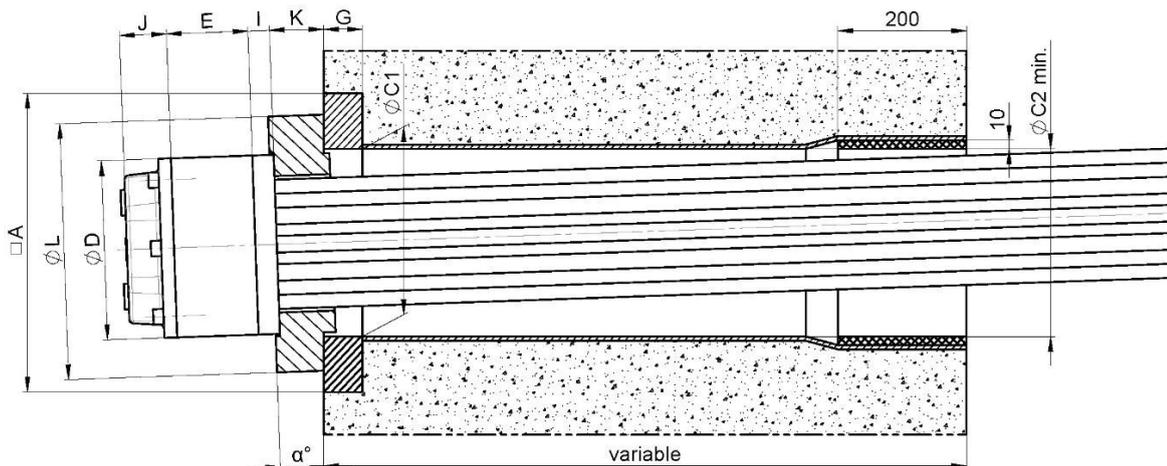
Ancrage type E-WT - Disposition avec plaque de calage – Dimensions
